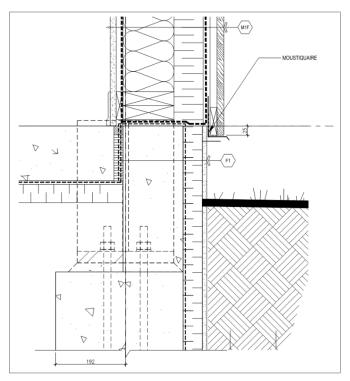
Détail de conception - jonction mur extérieur avec la fondation
